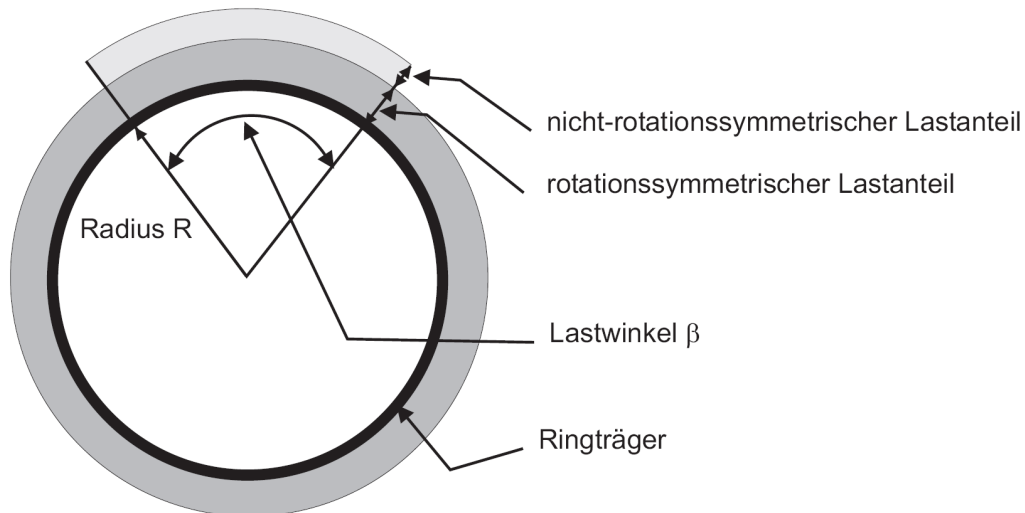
Grundriss eines Ringträgers mit Definition der Lastanteile und des Lastwinkels
